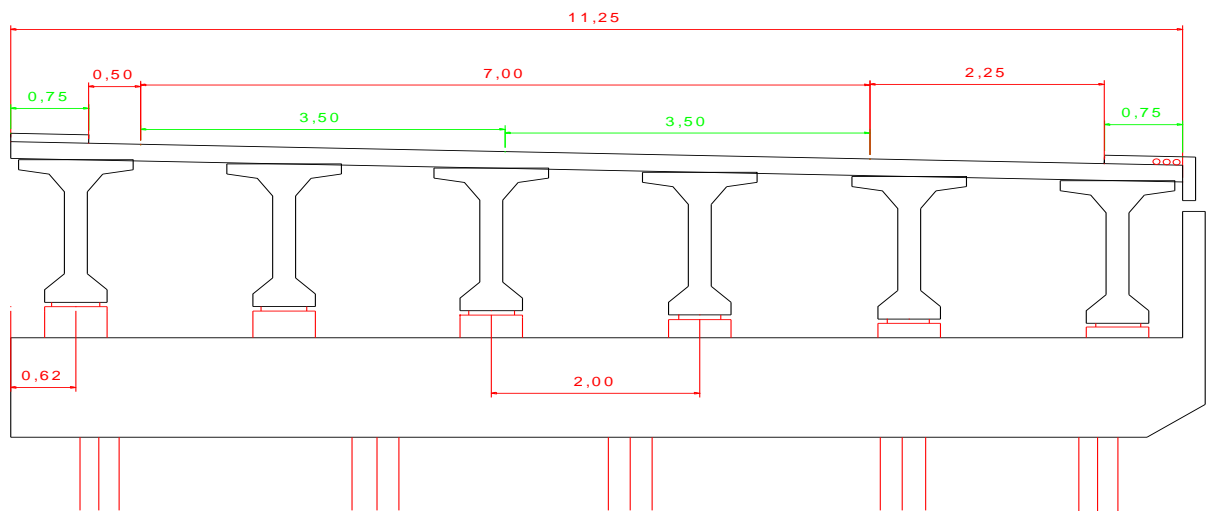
Coupe transversale du pont en post tension (avec un dévers $i = 2.5\%$)
